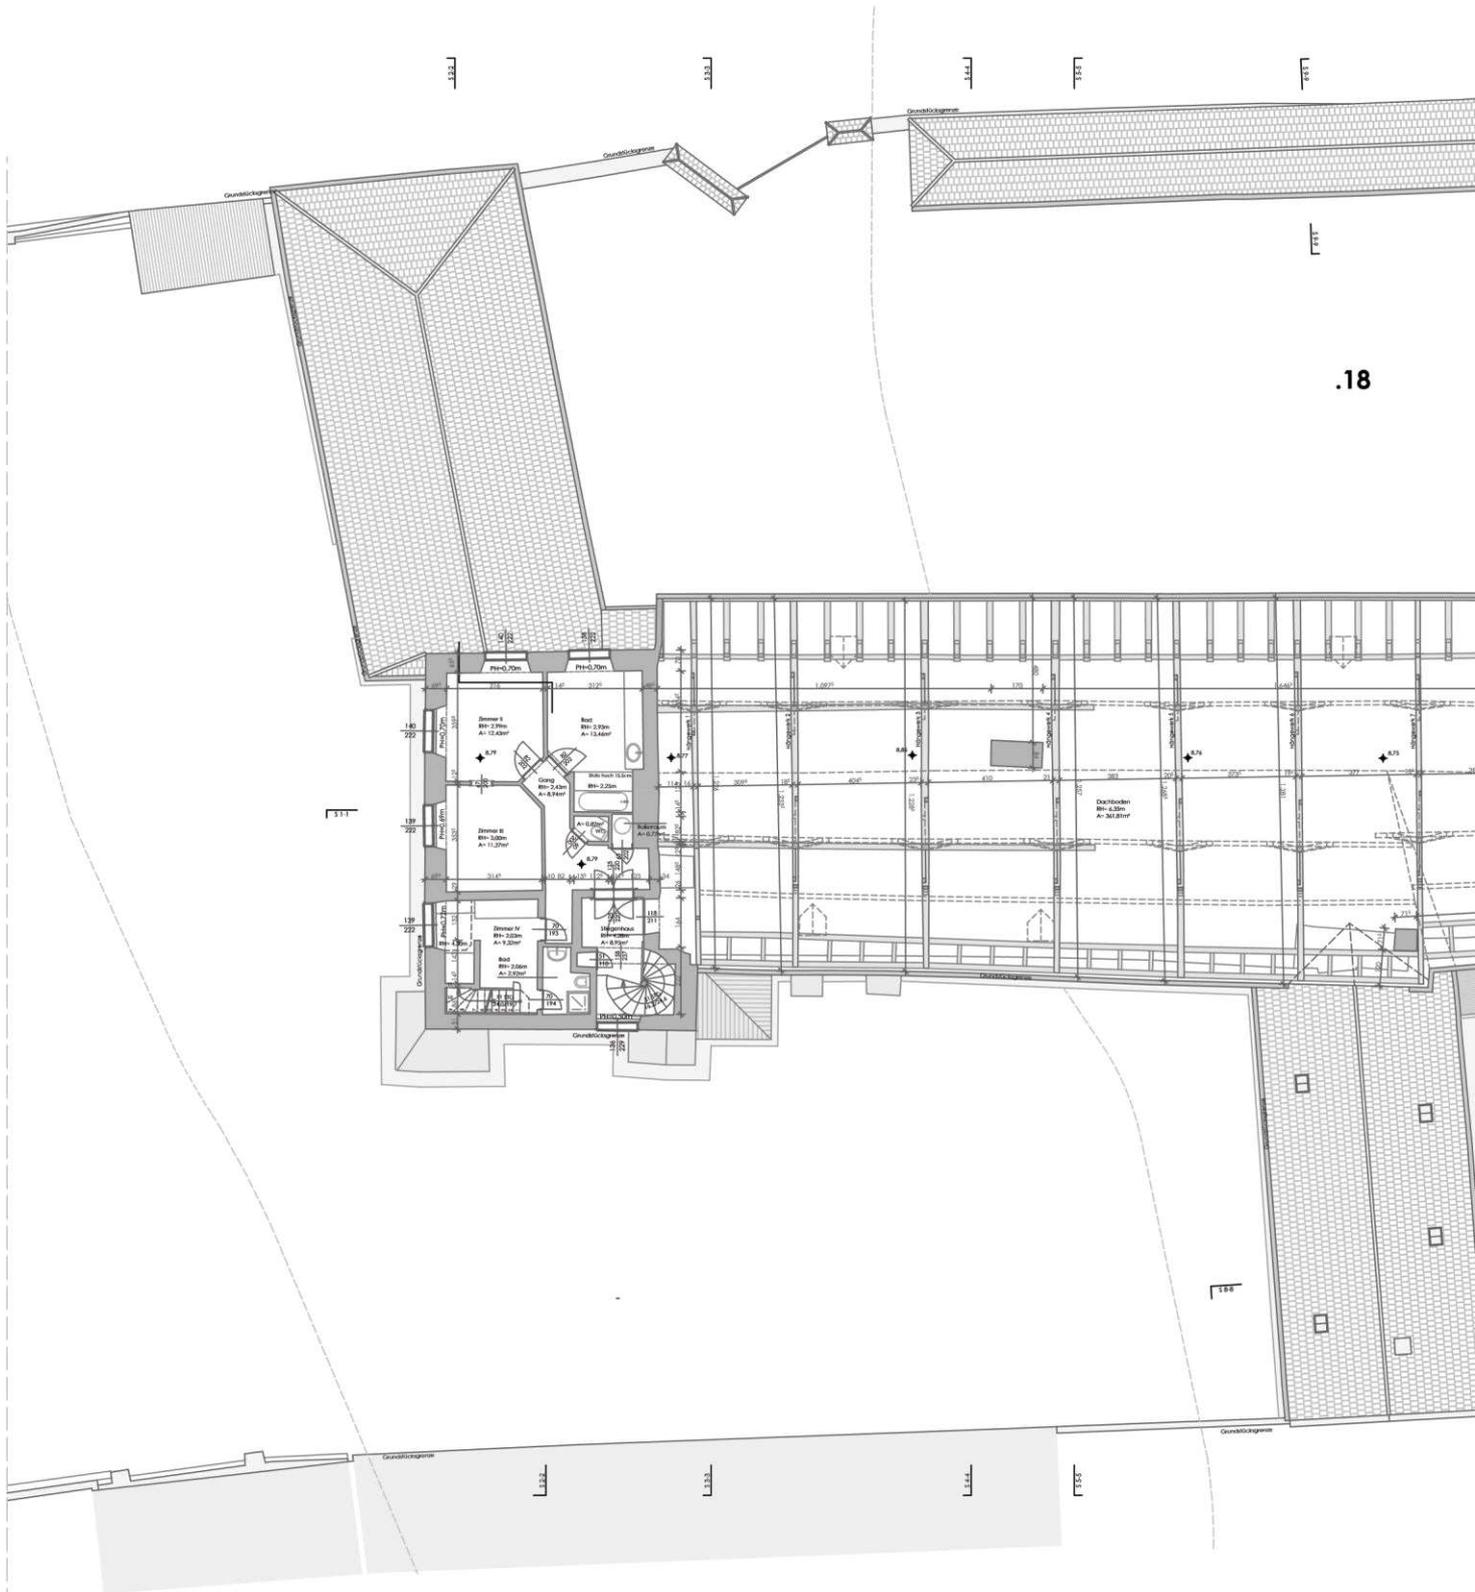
Bestandsplan Grundriss 2.Obergeschoss/ Dachboden-Übersichtsplan
